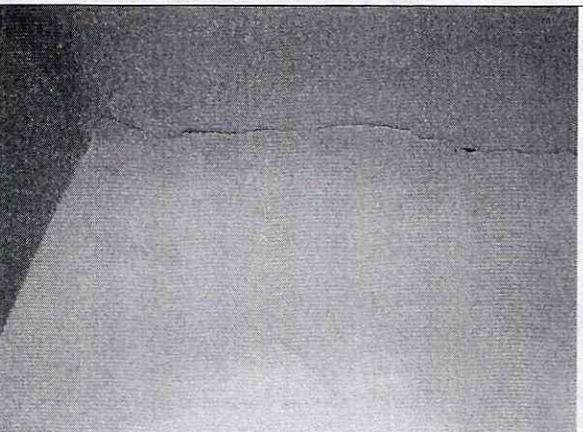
Fisuras y grietas en cielo raso bajo cubierta
